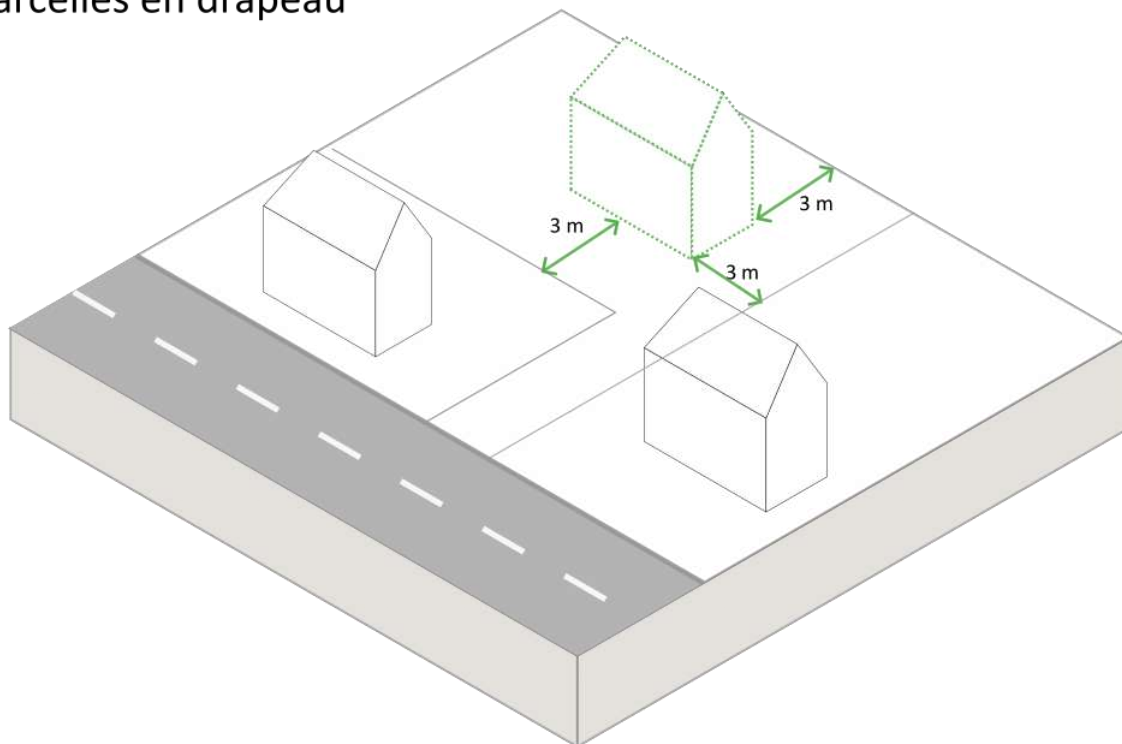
Schéma d'illustration des règles d'implantation pour les constructions en drapeau
